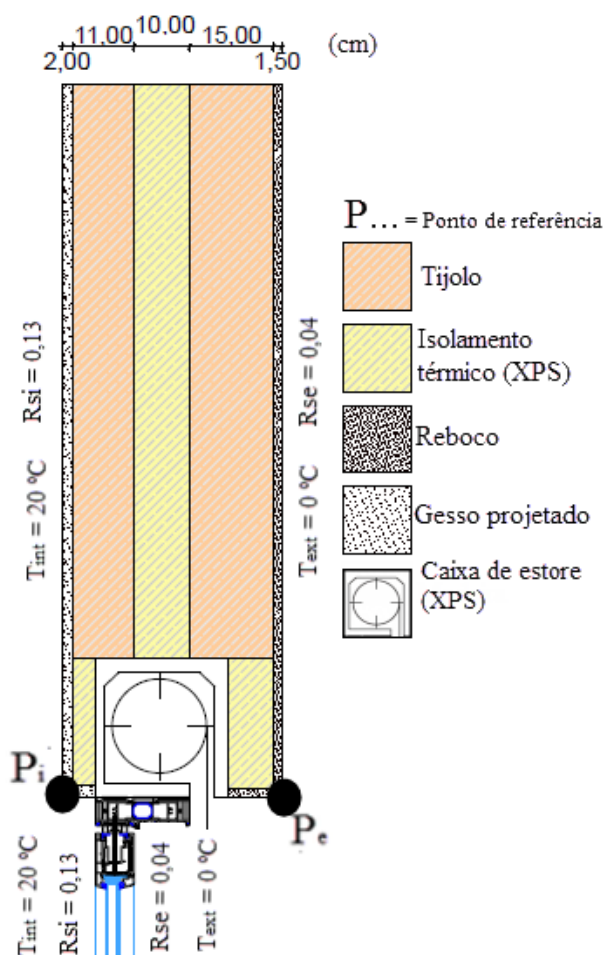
Ligação fachada (parede dupla) e caixa de estore/padieira
